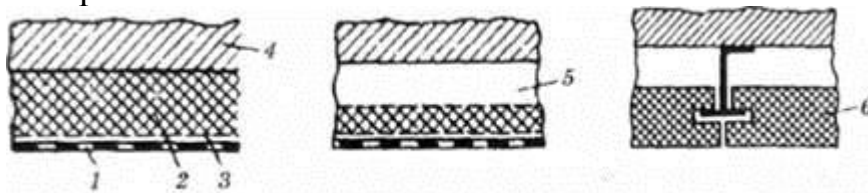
Види звукопоглинального облицювання: 1 - захисний перфорований шар; 2 - звукопоглинальний матеріал; 3 - захисна склотканина; 4 - стіна чи стеля; 5 - повітряний проміжок; 6 - плита з шумопоглинального матеріалу
